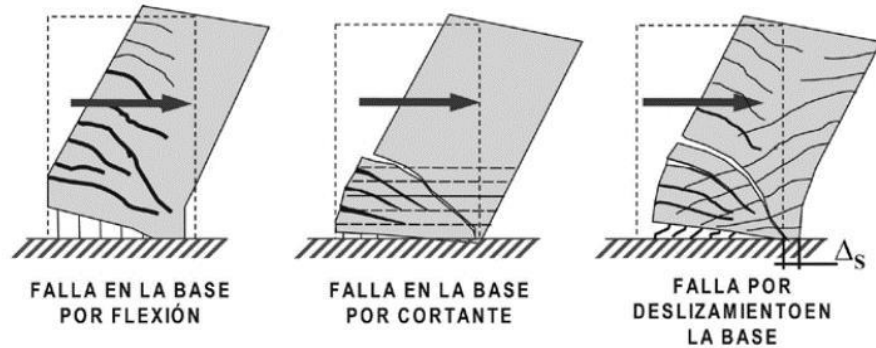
Fallas estructurales típicas en muros de concreto armado
